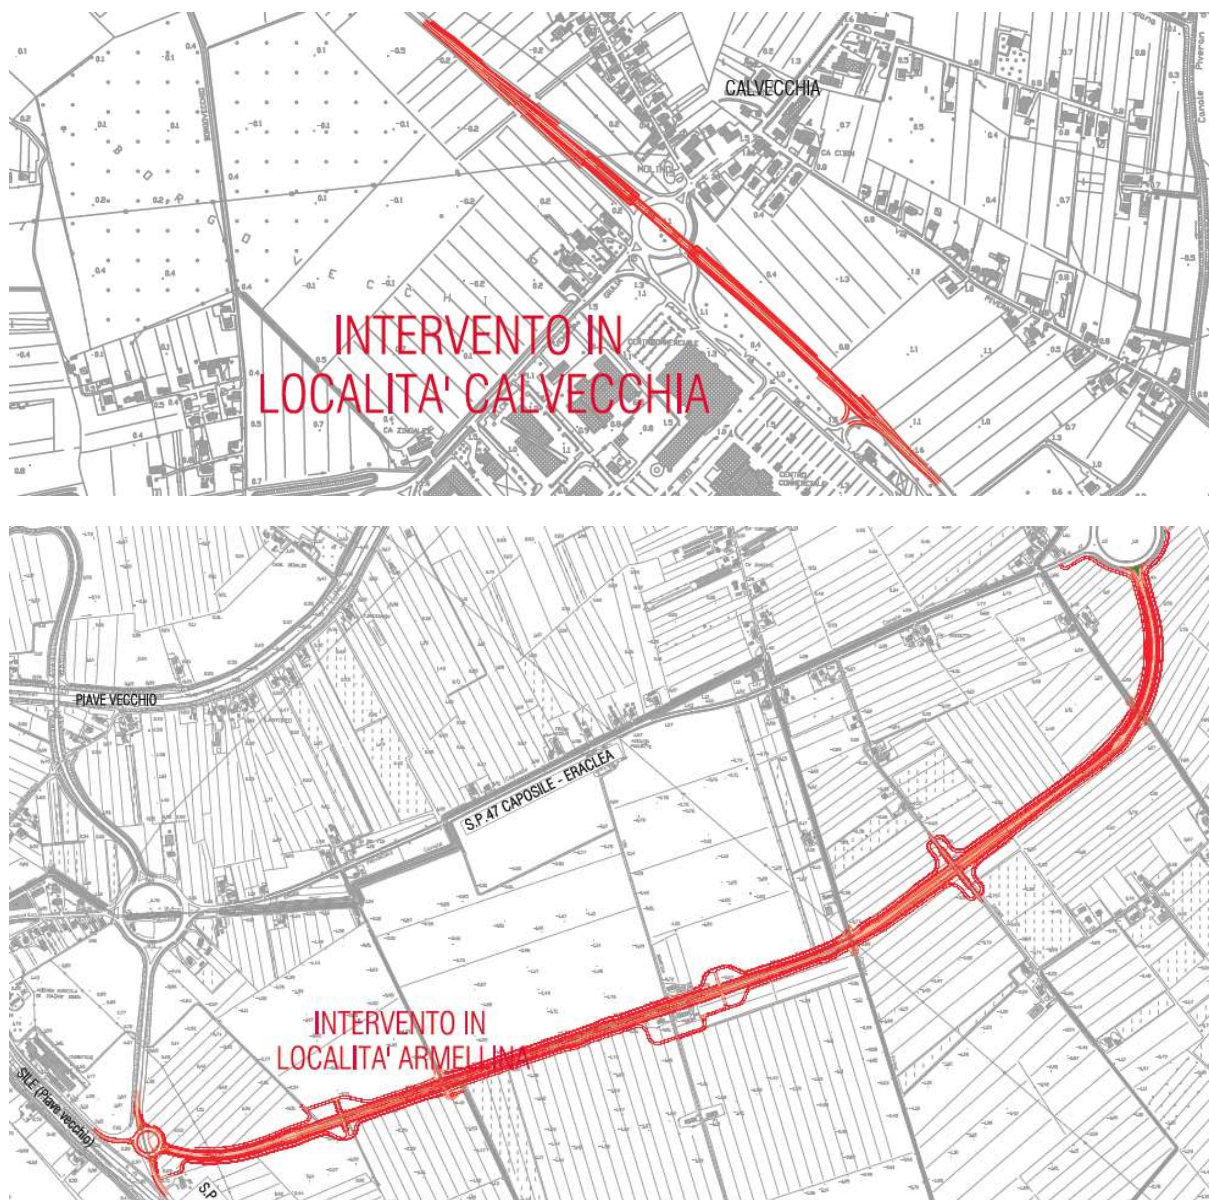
PLANIMETRIA DEGLI INTERVENTI
